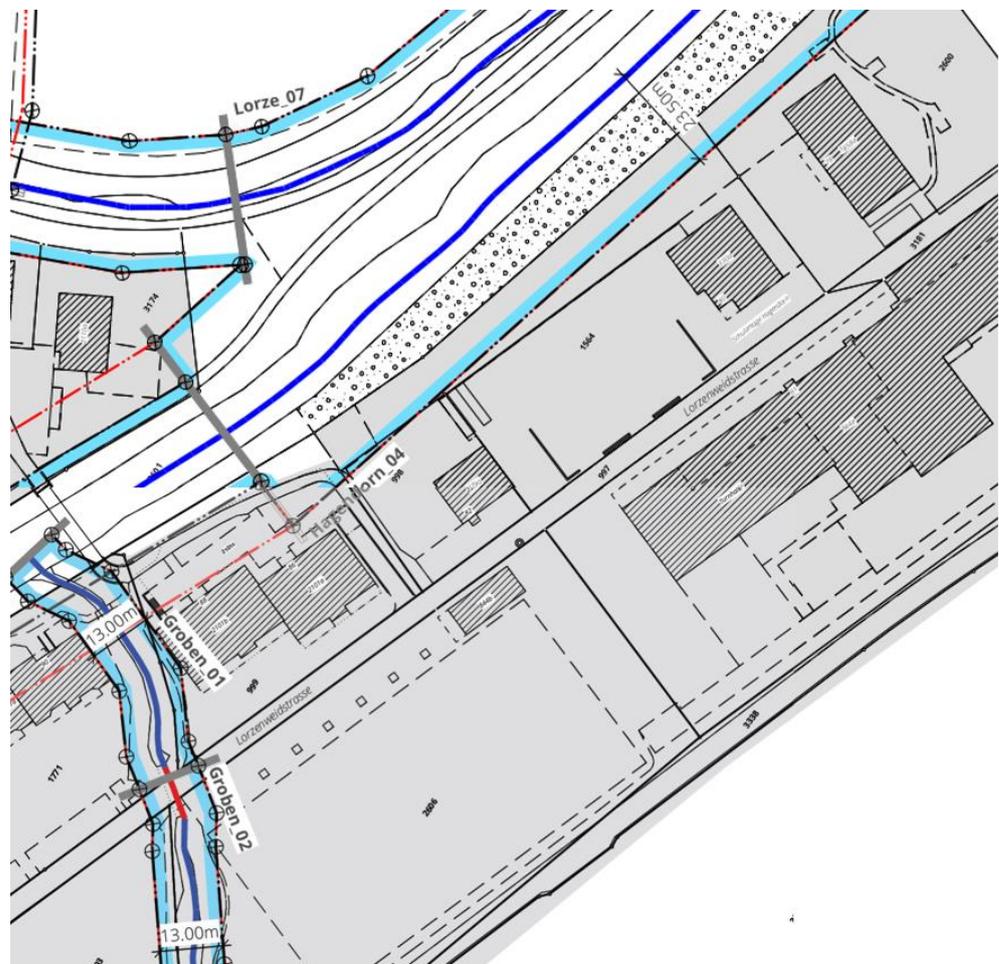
Ausschnitt Gewässerraumfestlegung Lorzenkanal und Grobenmoosbach, Entwurf z.H. Vorprüfung, Quelle: Gemeinde Cham
